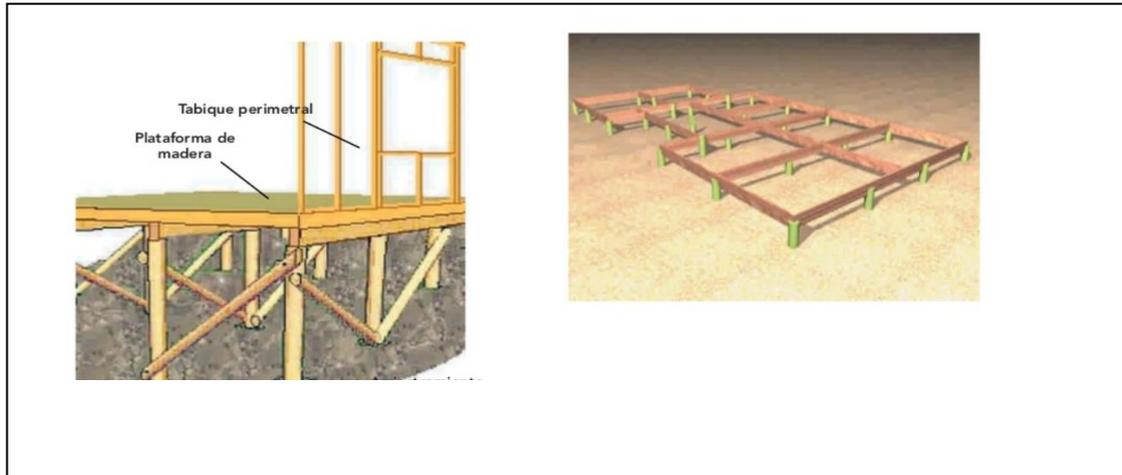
Fundación aislada por pilotes de madera que se encuentra en el libro construcción de una cabaña.pag.161
